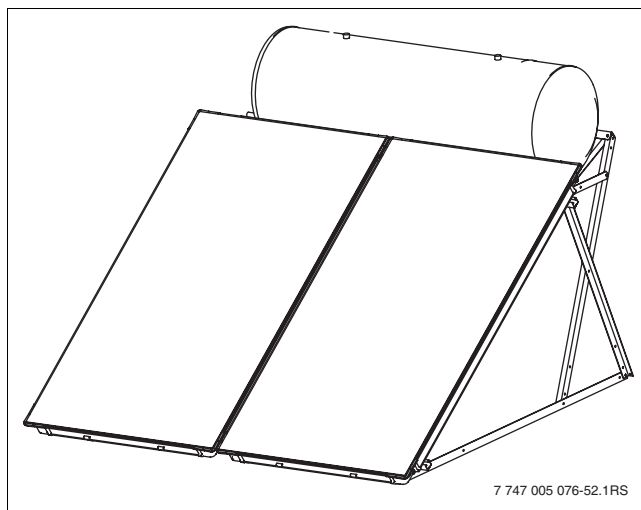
Vista montaje en cubierta plana (aquí sistema de 300 l)
